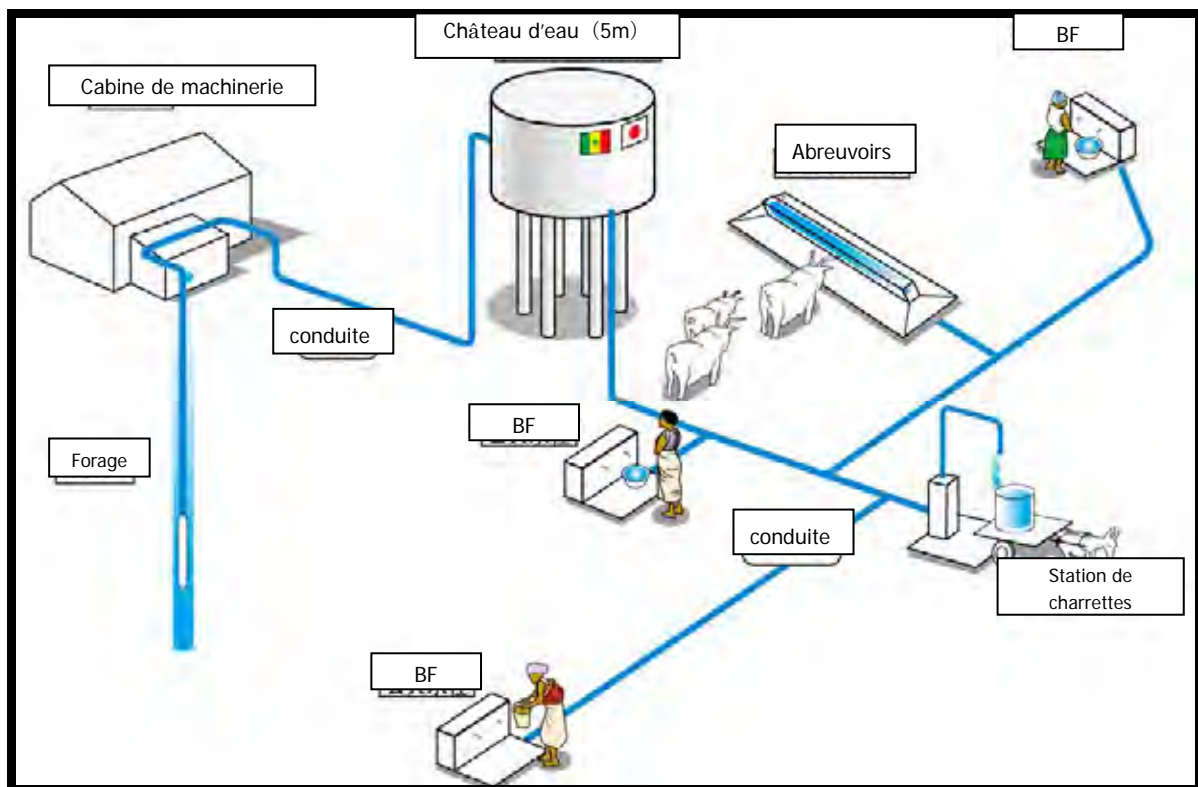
Adduction d'eau village (AEV): château d'eau de 5 m de hauteur (Type 2)
